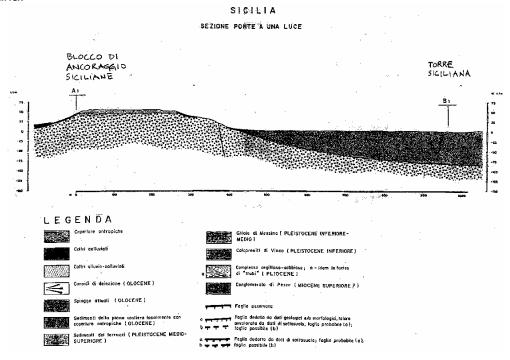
profilo geologico presso la fondazione della torre siciliana
